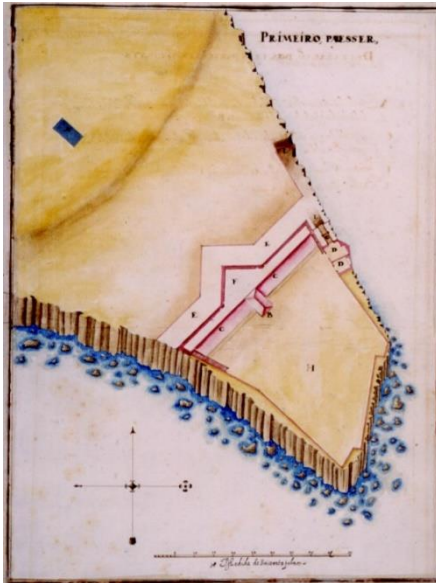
Primeiro parecer para a Fortaleza de Santa Catarina de Baixamar. Segue uma planta semelhante à já proposta em 1617. Folha nº29.
